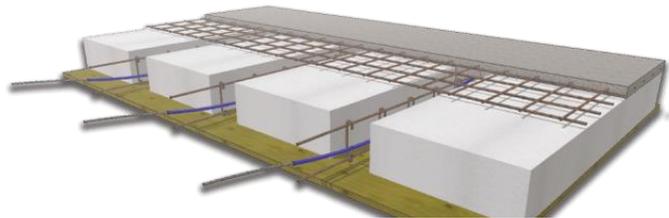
Losa reticular. Fuente: <https://gruposotex.com/losas-de-entrepiso/isofill/isofill-galeria/>. [16/10/20]
